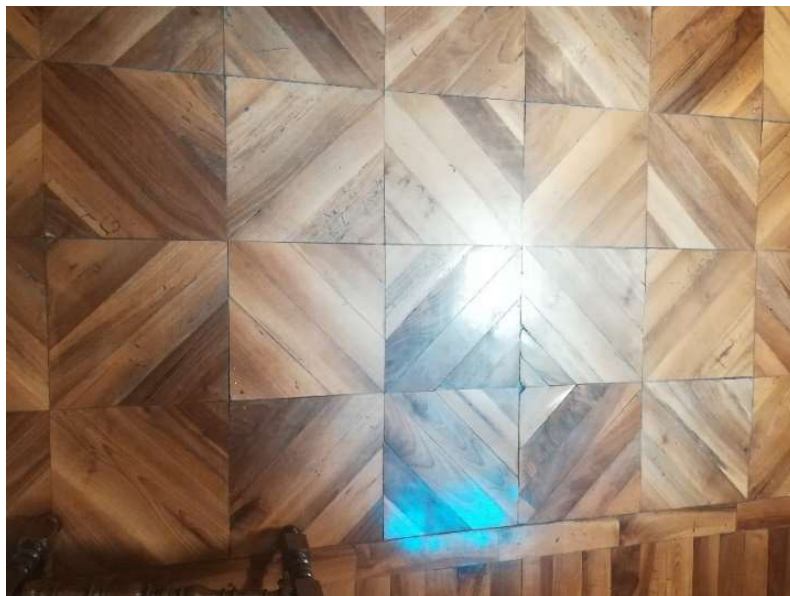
vista del parquet quadro centrale pavimentazione Camera di Consiglio
